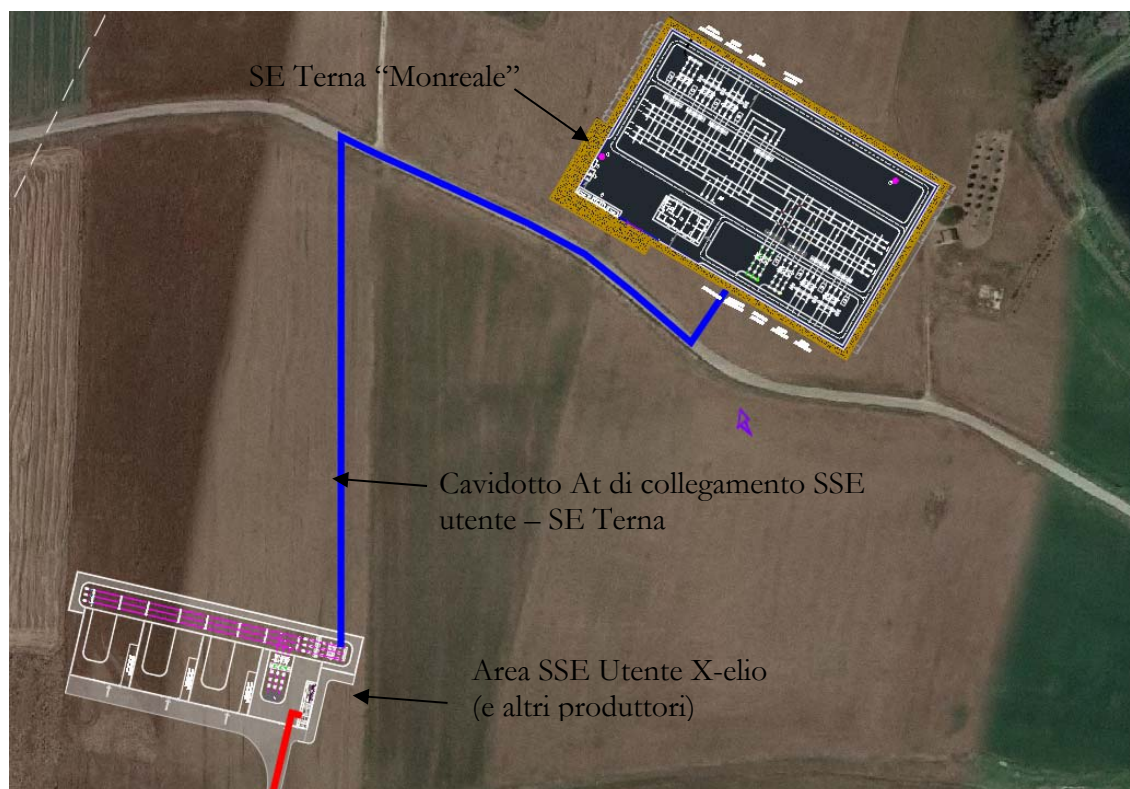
Planimetria con individuazione nuova SSE e elettrodotto di collegamento alla SE Terna esistente
